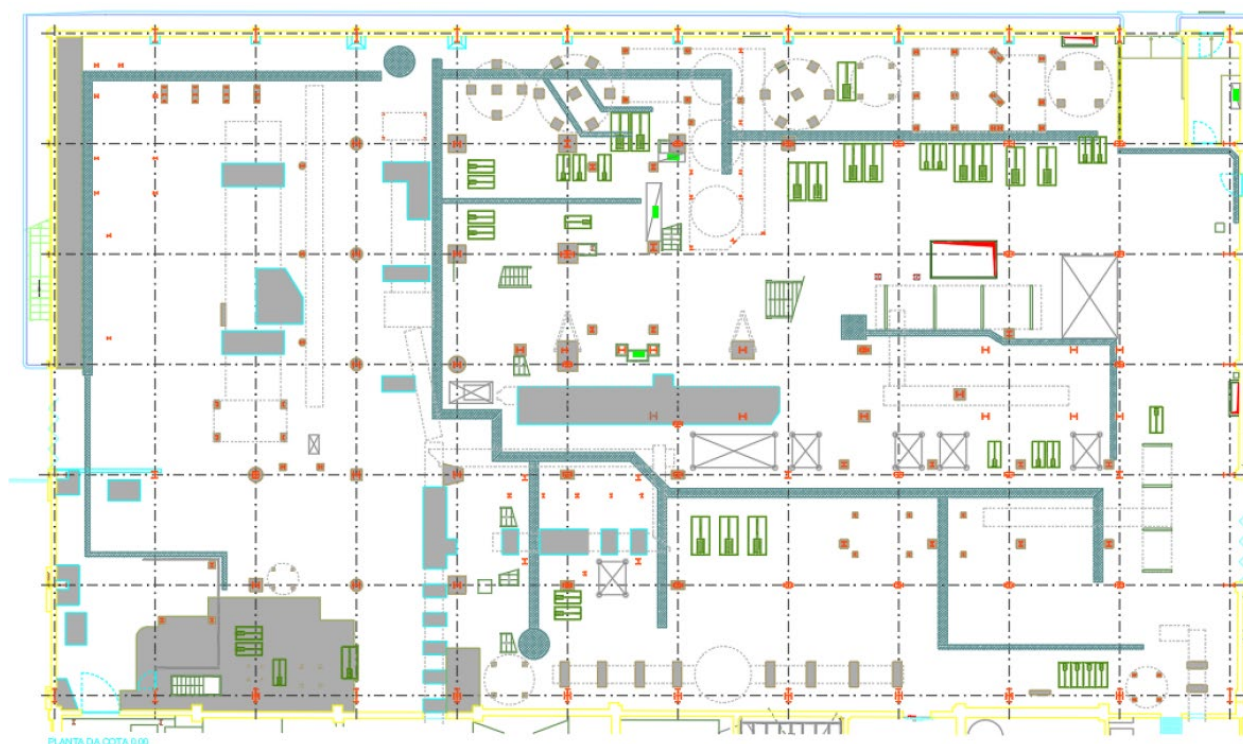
Planta do existente no piso térreo (Eleven Steps, 2022)
